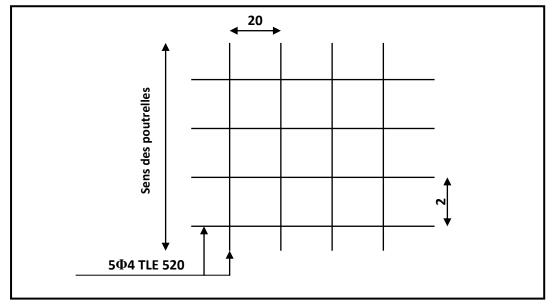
Ferraillage de la dalle de compression avec un treillis soudé 20x20 cm
